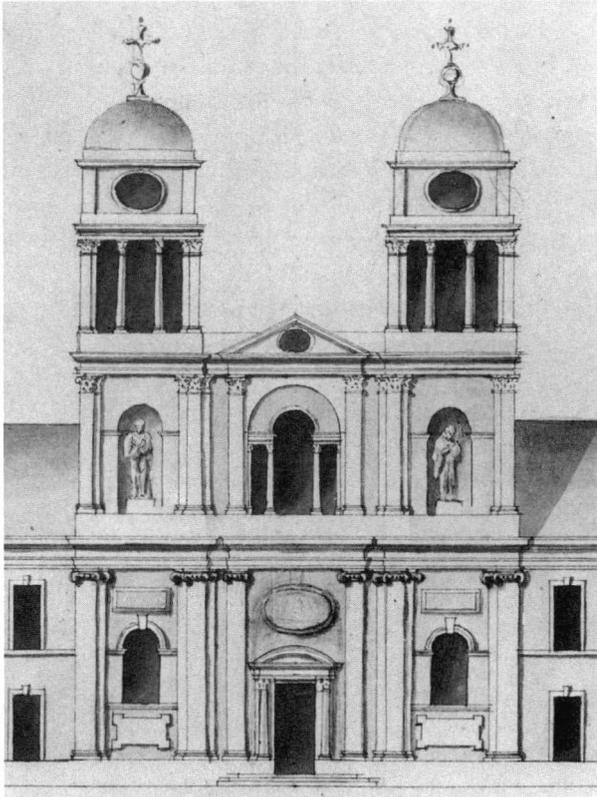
Élévation de la façade de l'abbatiale d'Afflighem construite par Dewez (*Copyright* AGR, Plans Dewez, n° 124, détail).
